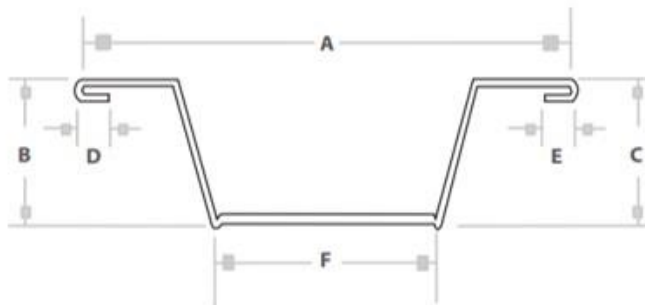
Sección transversal y dimensiones nominales de Canal Listón (REY, 2016)
